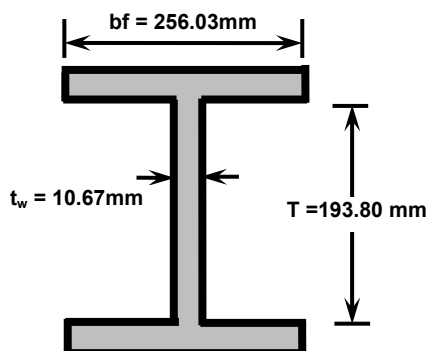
Dimensiones para longitud de la soldadura de un perfil W.
